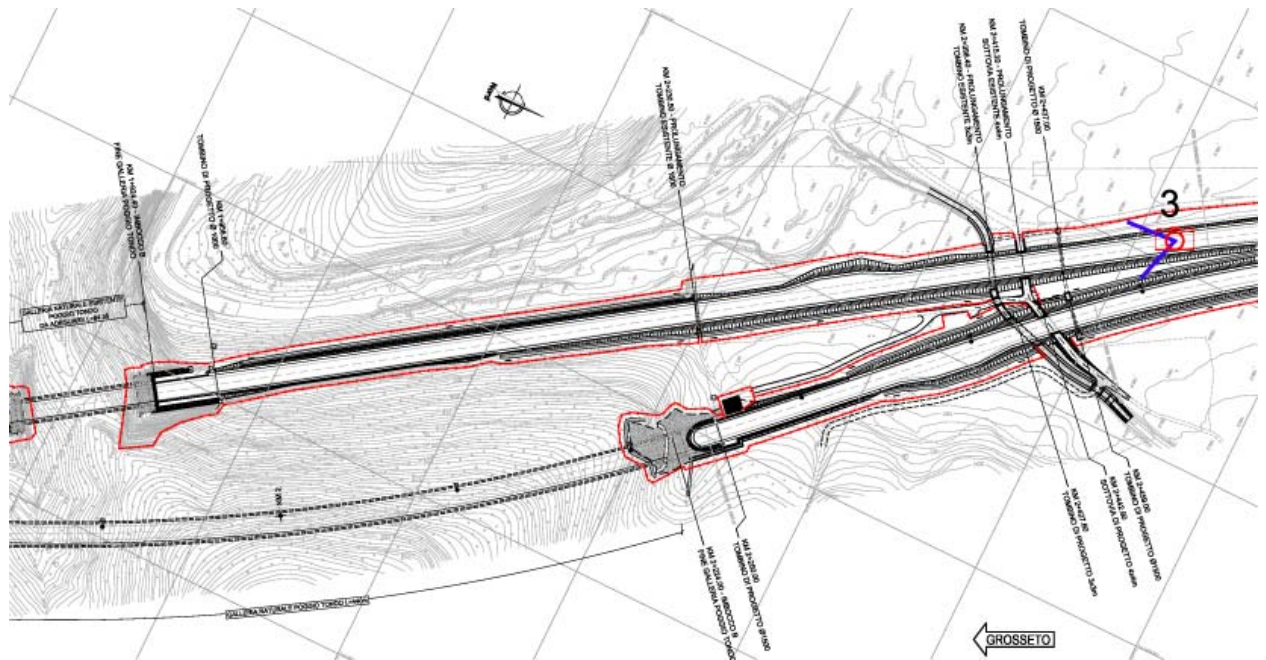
Vista 3 – Planimetria dell'opera con punto di vista fotografico
